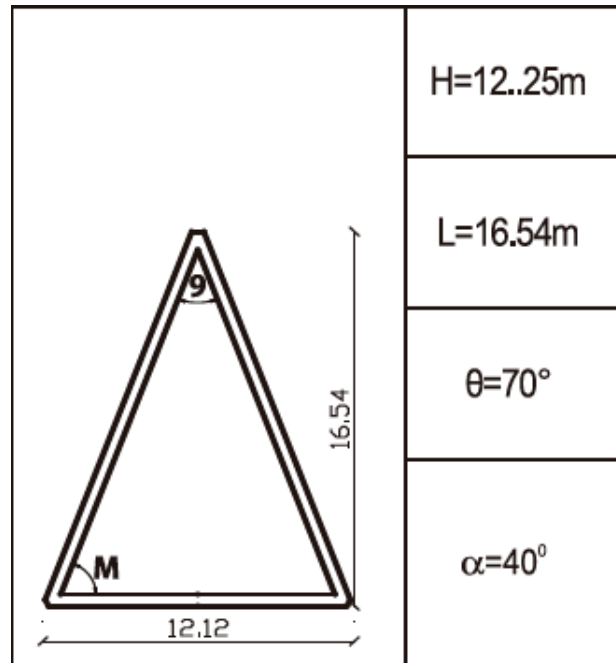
Subdivisión módulo del *diagrid*. Fuente: International Journal of SEWC. Structural Engineers Work Congress.
